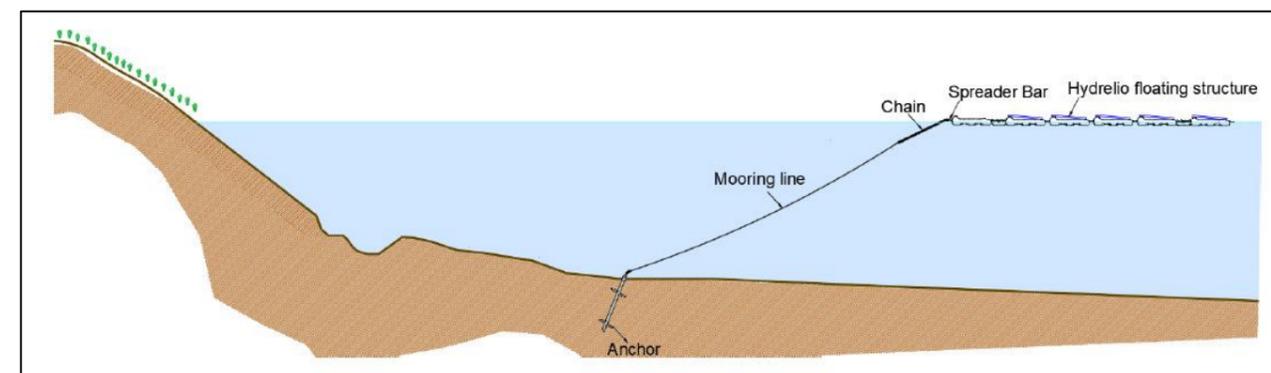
Exemple d'ancrage au fond (source : Ciel et Terre)
